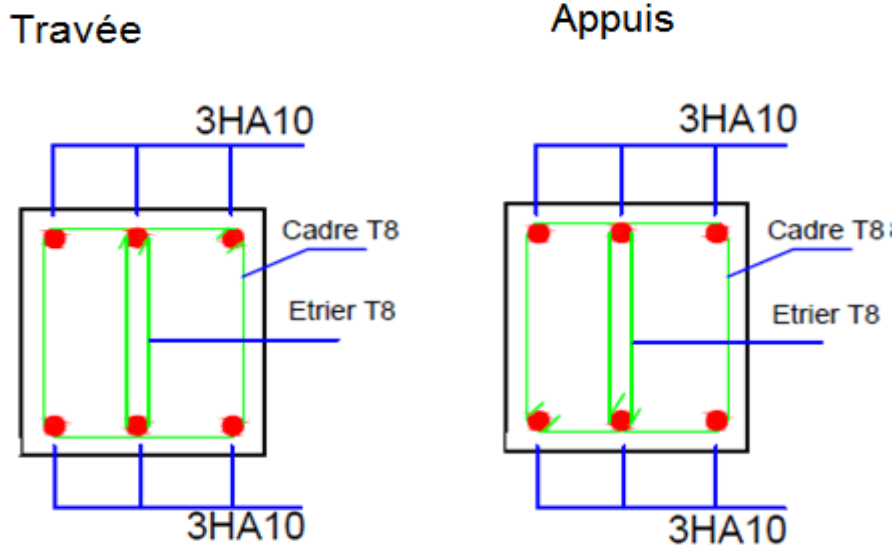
Schéma de ferraillage de la poutre de chaînage
